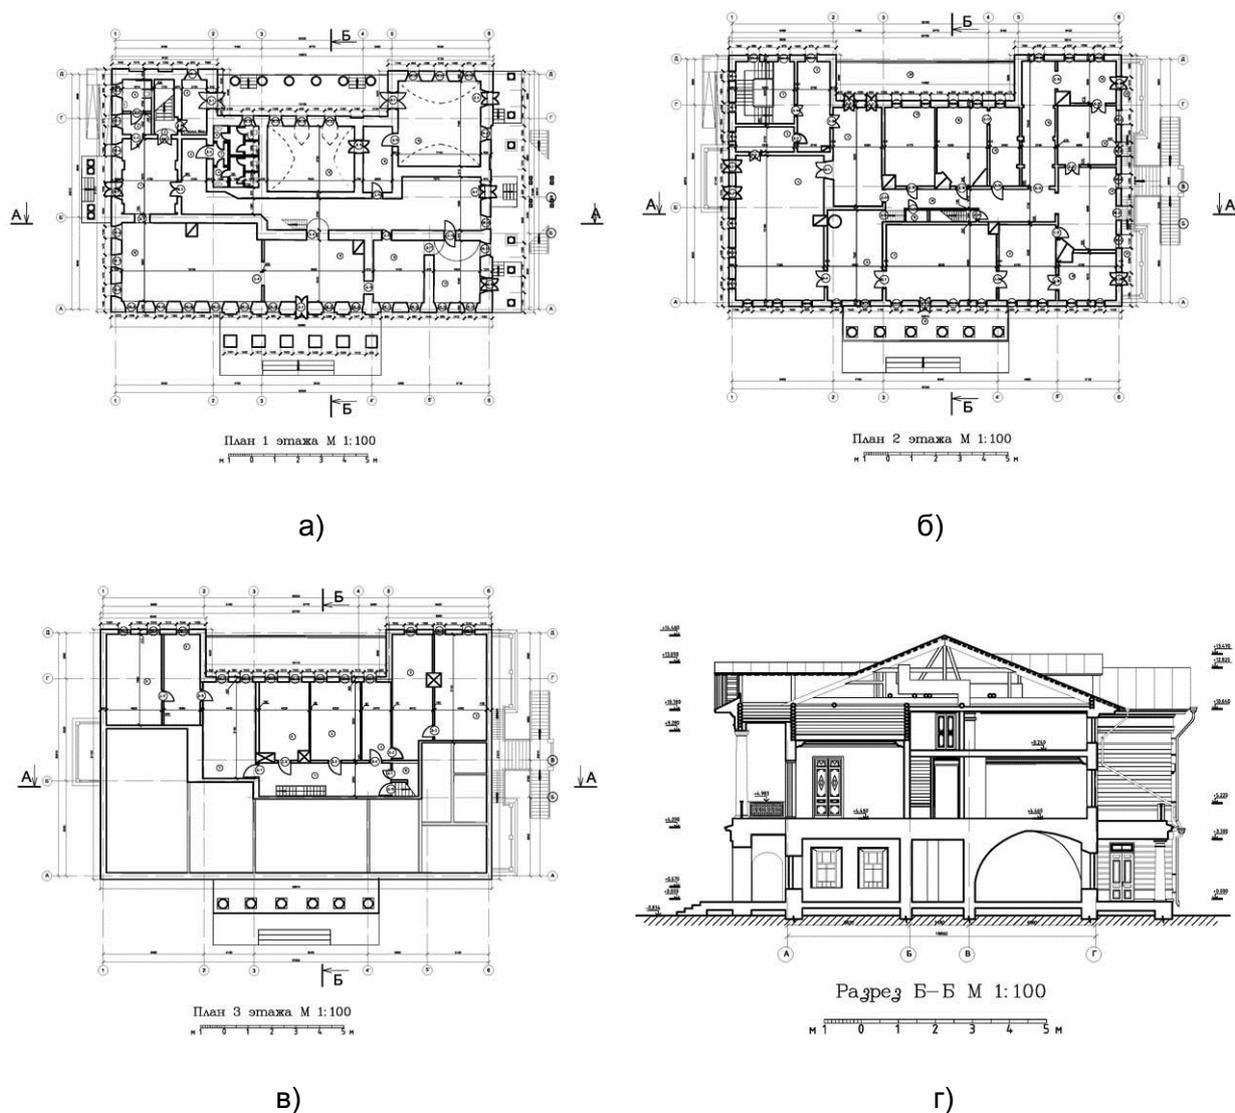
Главный дом: а) план 1-го этажа; б) план 2-го этажа; в) план антресольного, 3-го этажа; г) поперечный разрез (проект реставрации выполнен АУК ВО «Вологдареставрация», 2019г. Руководитель авторского коллектива И.К. Белоярская)
